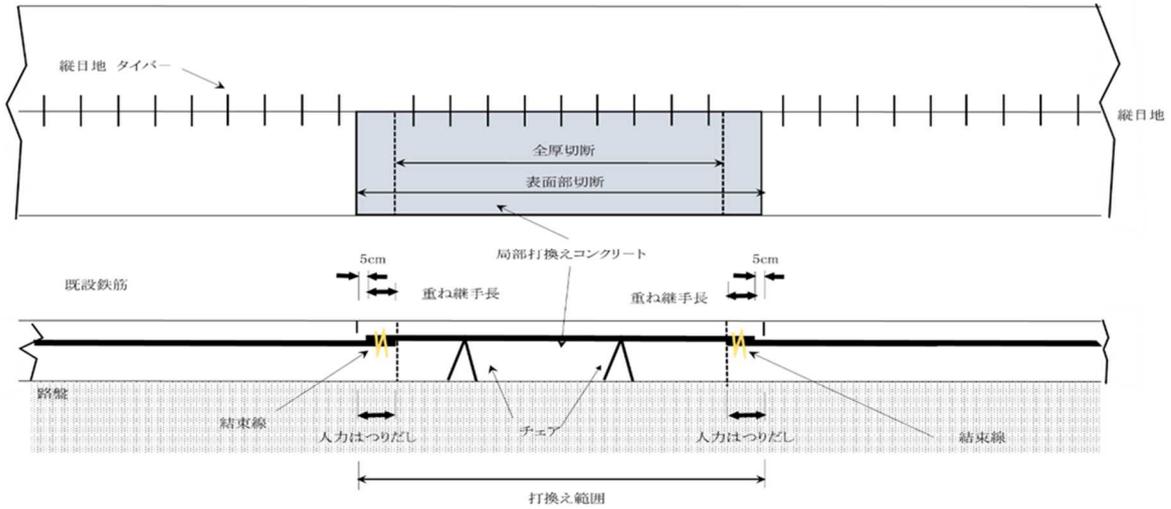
連続鉄筋コンクリート舗装の局部打換え
